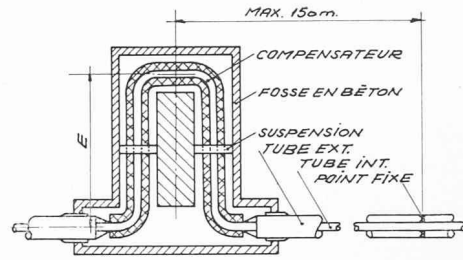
Vue en plan d'une conduite double-tube, système Winter, enterrée, en terrain plat.
